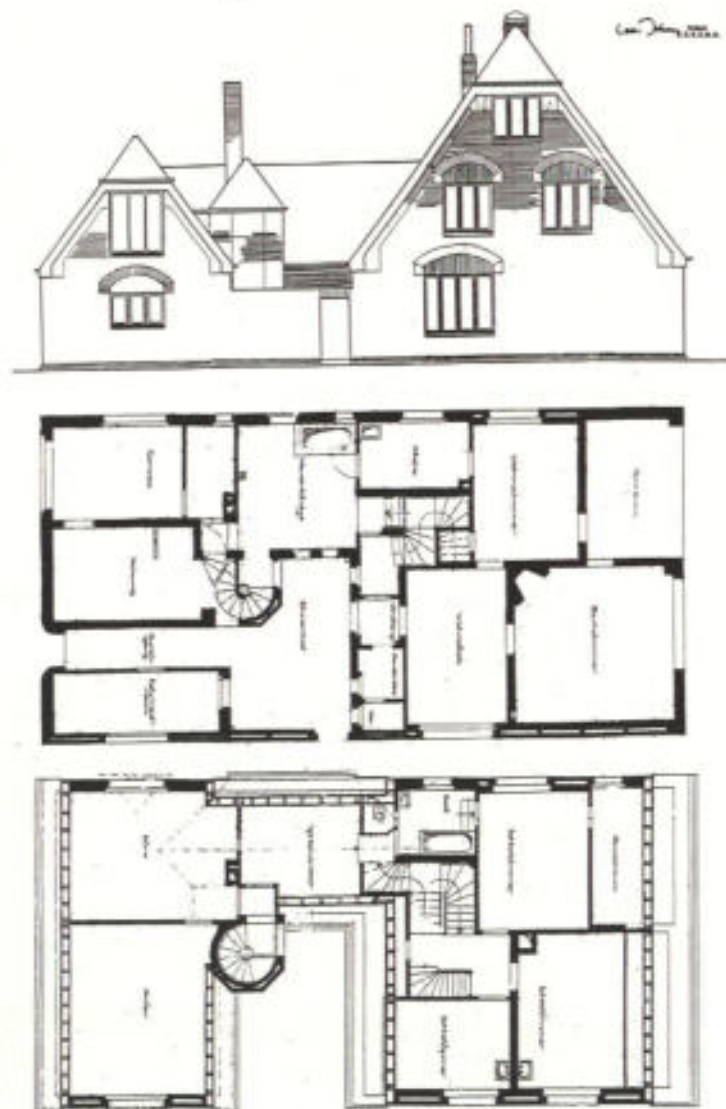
Eigenes Wohnhaus An der alten Burg 1; Grundrisse und Ansicht
